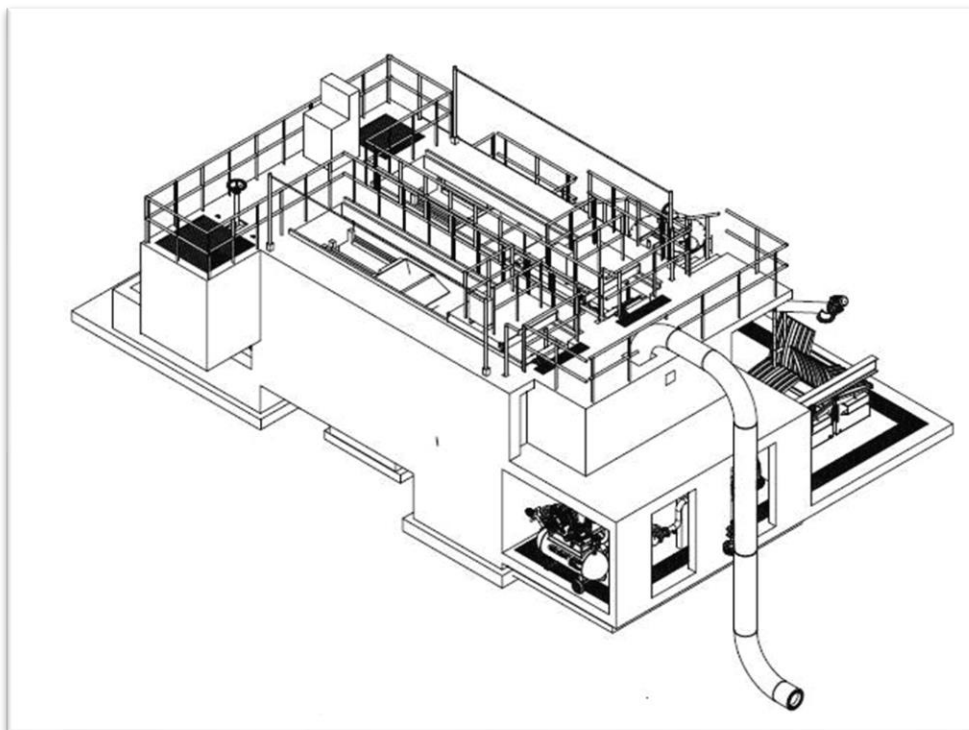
Vista isométrica de la Unidad de desarenado y desengrasados. Fuente OPISU.
